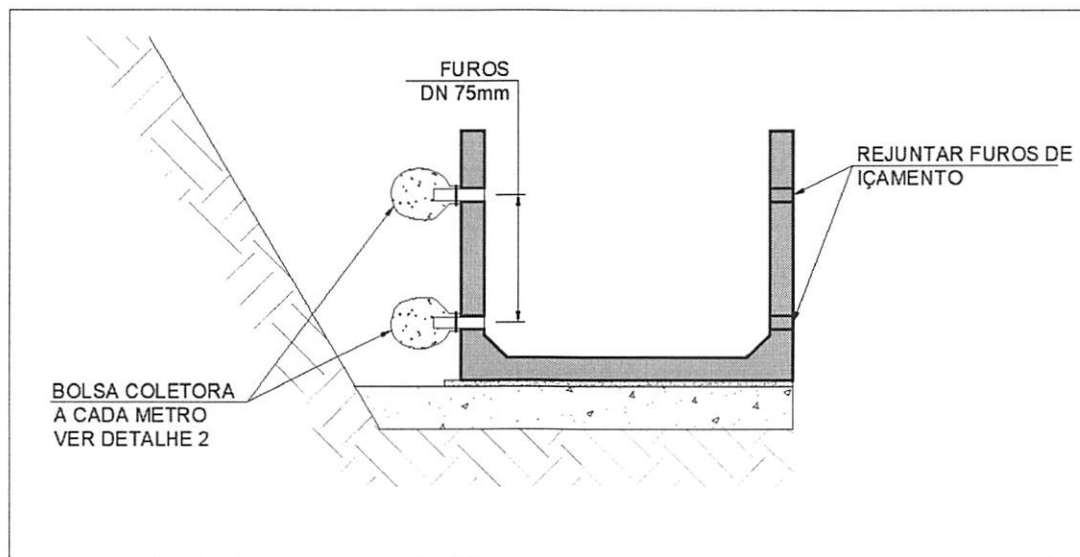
DRENO LATERAL - CANAL COM DRENAGEM EM APENAS EM 1 LADO
